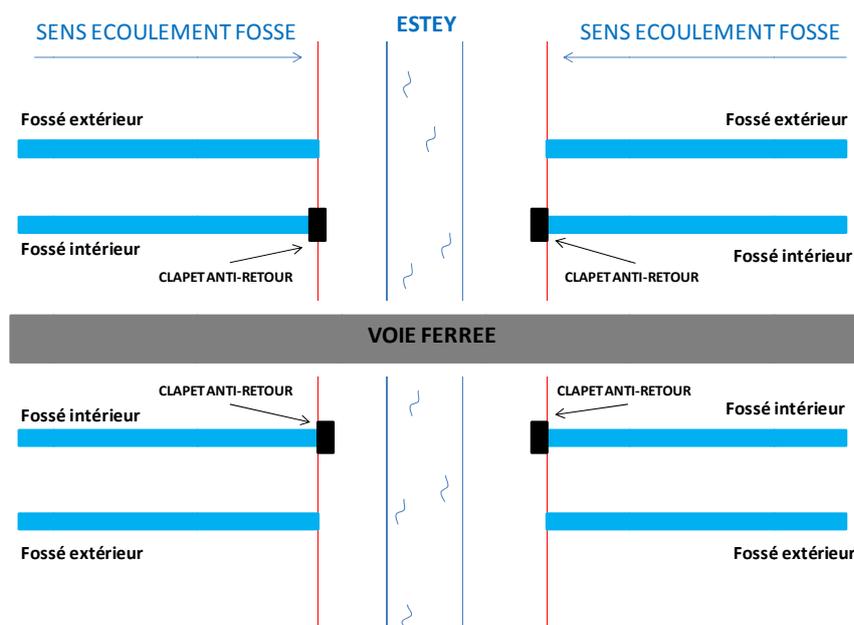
Schéma de principe de drainage de ligne ferroviaire Bassens-Bec d'Ambès. Coupe longitudinale. (Source Simethis)
